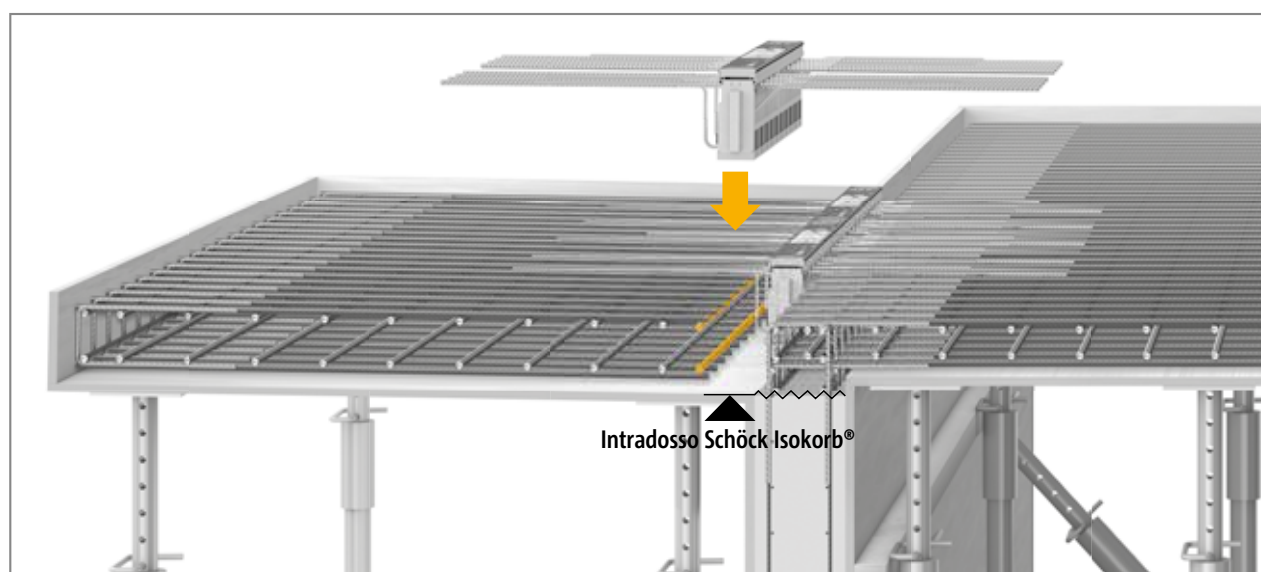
Schöck Isokorb® tipo K, preparazione dell'armatura e montaggio
